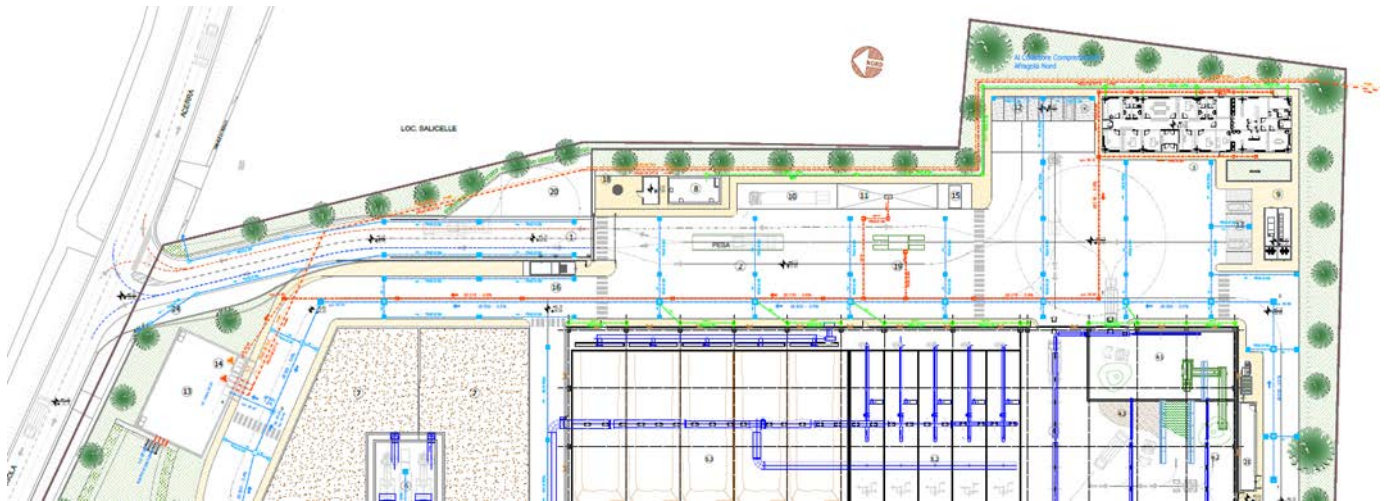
In rosso è rappresentata la rete smaltimento acque nere. Stralcio planimetria 1137-D-I-PL-04-0
